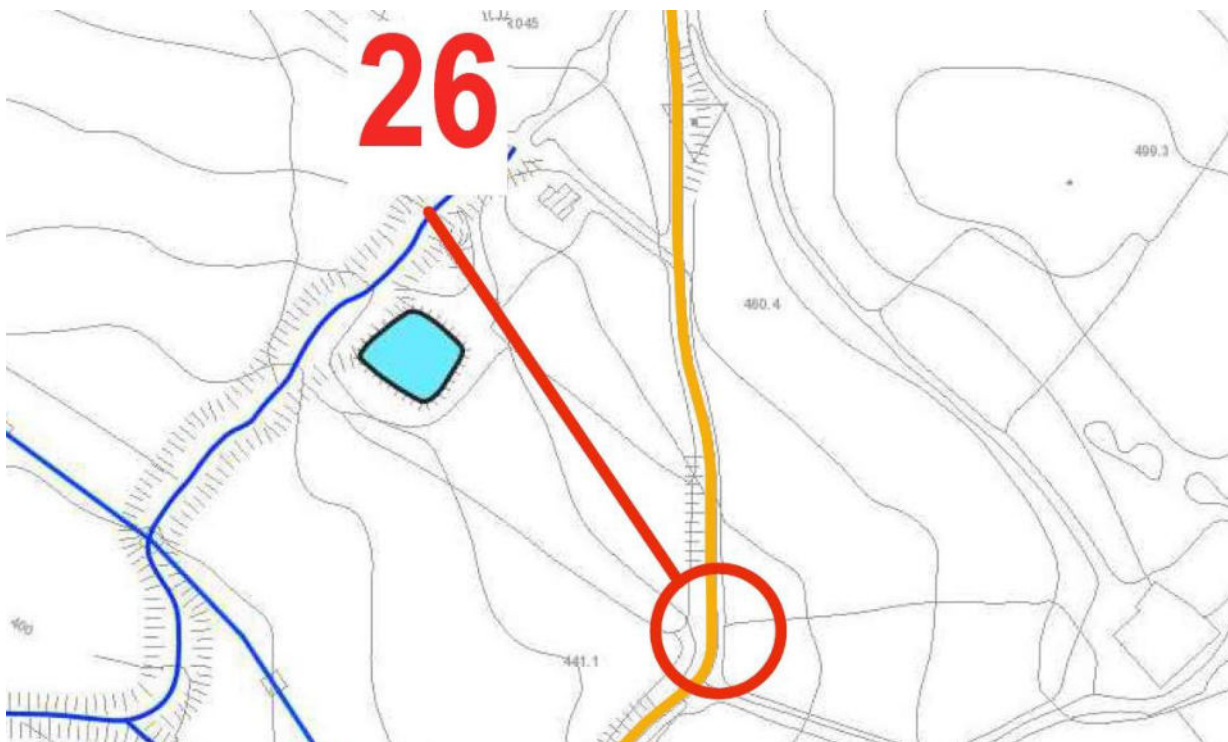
Planimetria CTR con individuazione attraversamento in cls
